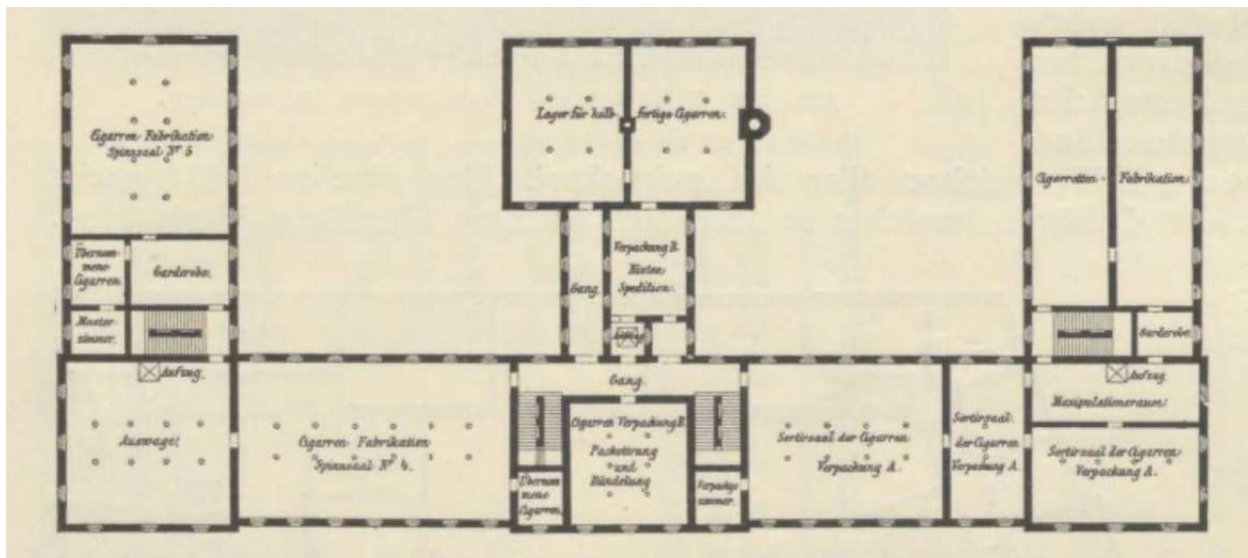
Tabakhauptfabrik in Ottakring, Grundriss.
